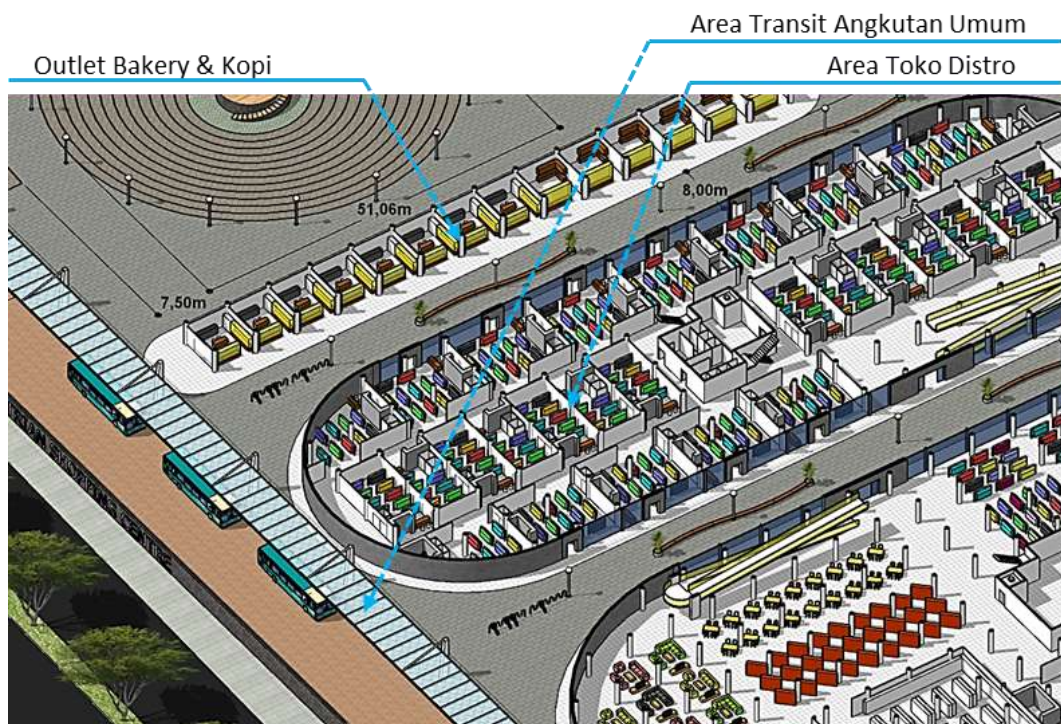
15 Lay Out Plan Kompleks Bangunan dan Lingkungan Sekitar
